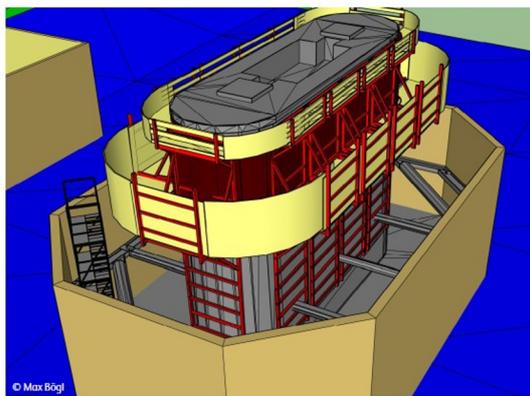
施工現場の手摺の設置等の安全に関連する側面を BIM モデルにより表現している例 ³⁴⁾
